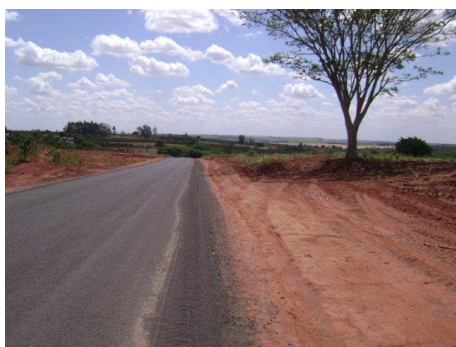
Estrada pavimentada logo após realização das obras do Melhor Caminho (ITP-156 - Itápolis)
